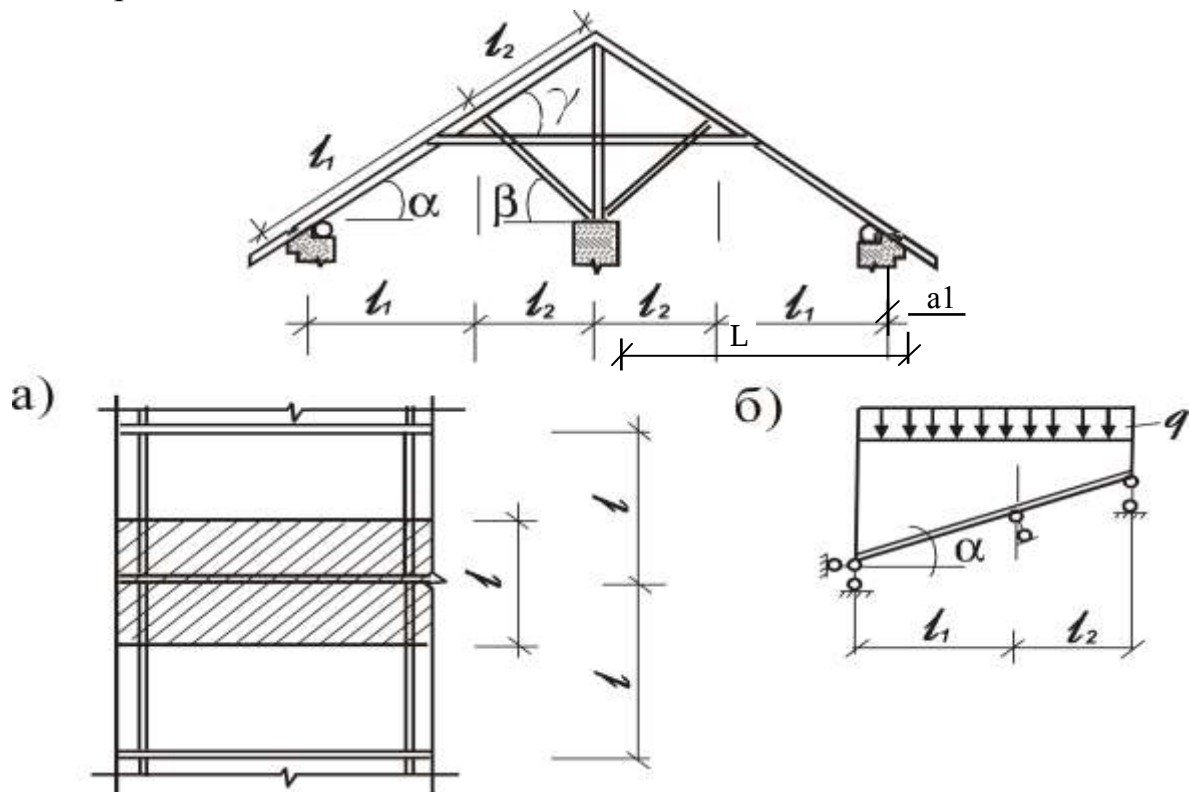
Наслонные стропила с подкосами и затяжкой: а- грузовая площадь; б – расчетная схема
